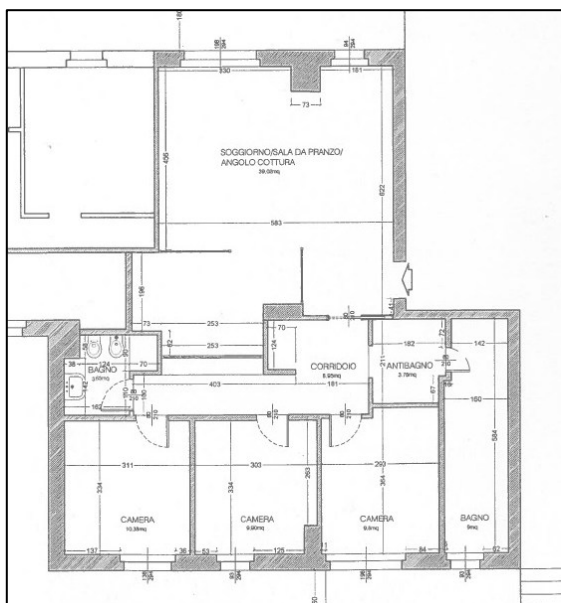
Planimetria aggiornata ad ottobre 2014
